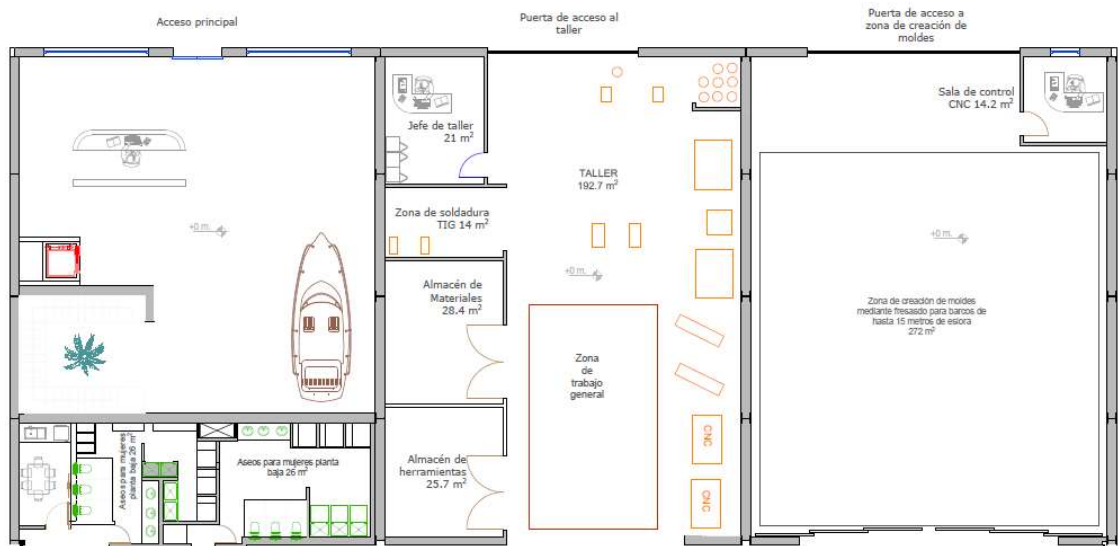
Detalle de distribución de las zonas anteriormente comentadas
